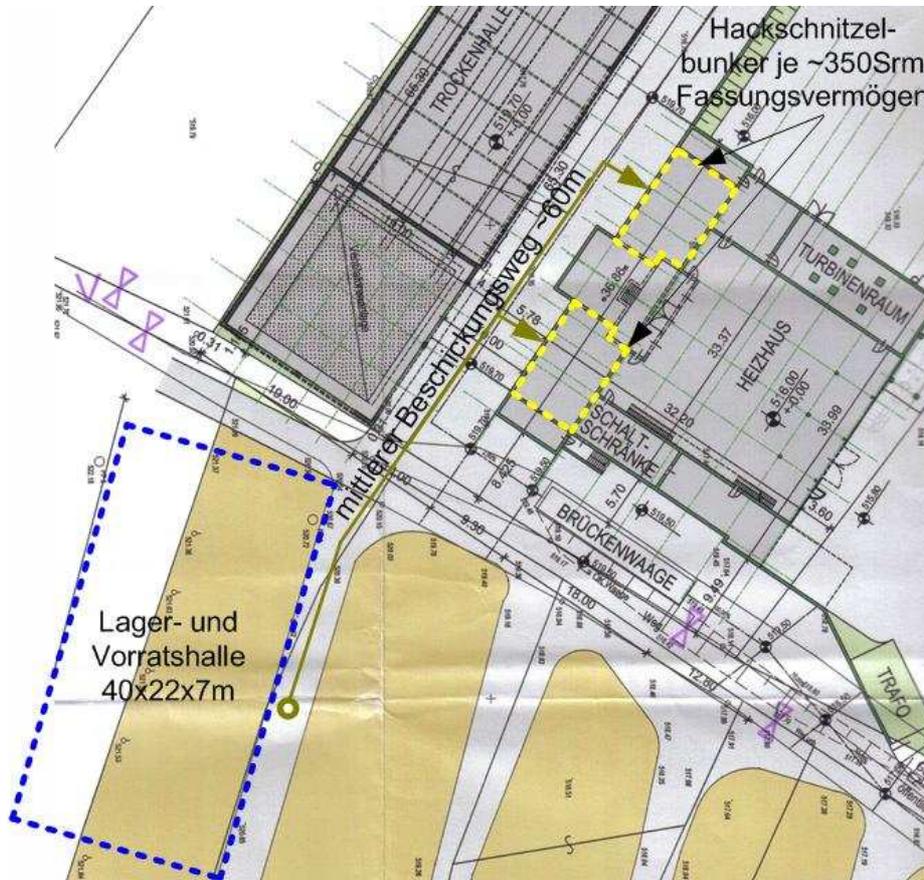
Lageplanskizze der Lager- und Vorratshalle
